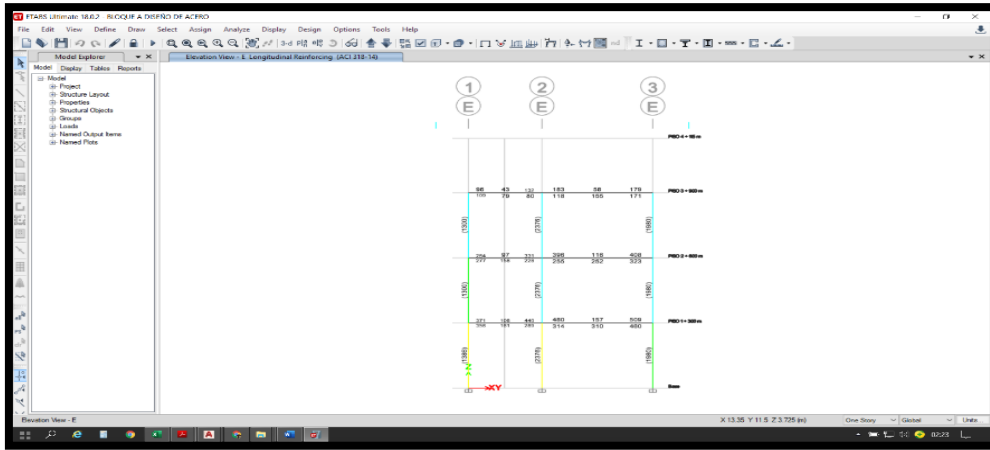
Bloque B - Acero longitudinal en el eje elevación eje E-E
